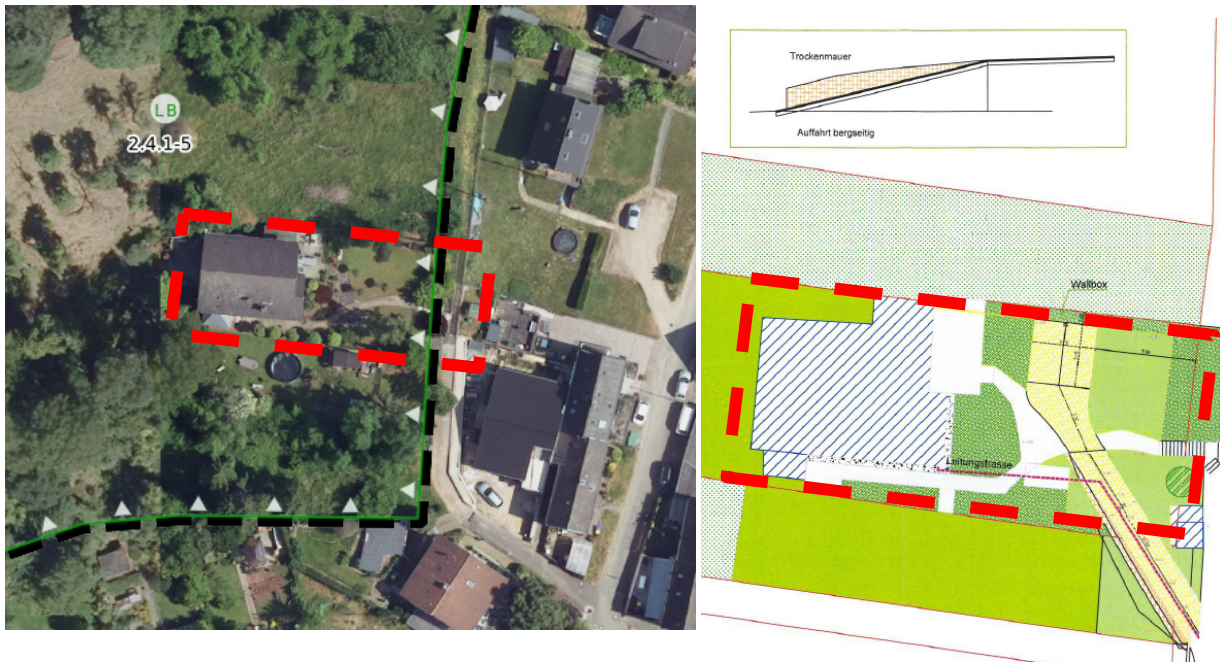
Luftbild mit Abgrenzung des geschützten Landschaftsbestandteils und der Ortslage Kreuzau-Winden (links); Planzeichnung (rechts)
